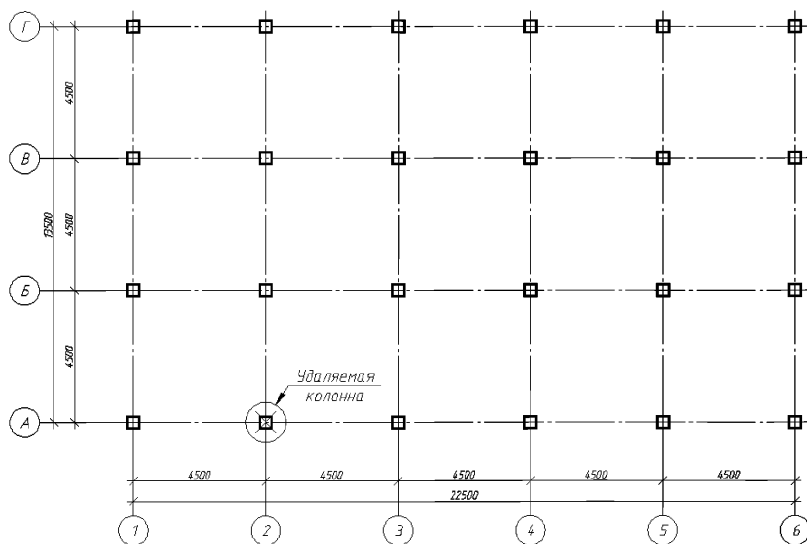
Схема плана железобетонного многоэтажного здания с монолитным железобетонным каркасом
